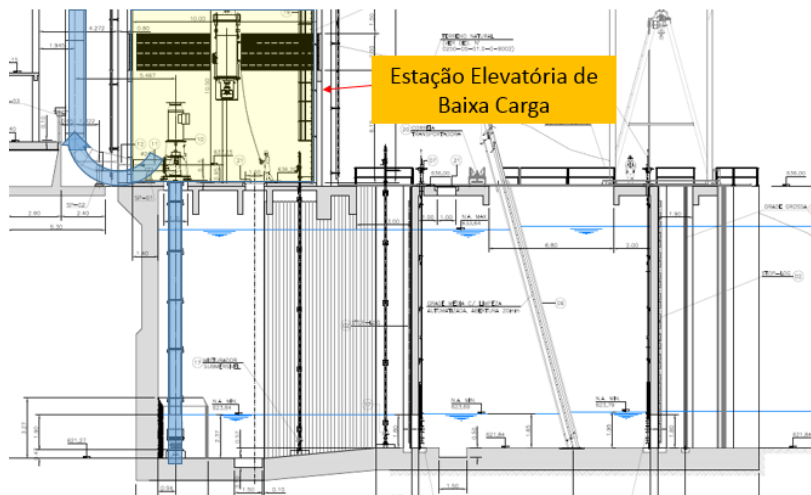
Estação Elevatória de Baixa Carga, vista em Corte
